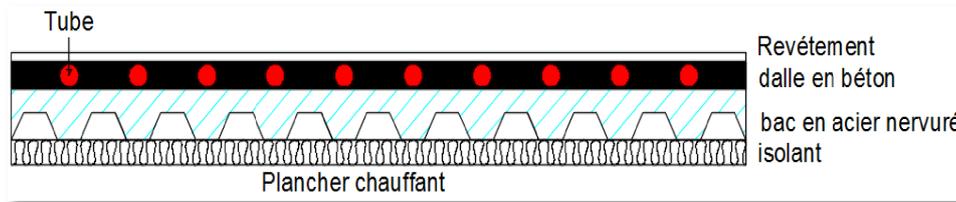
détails 3 du plancher chauffant ; source : auteur
